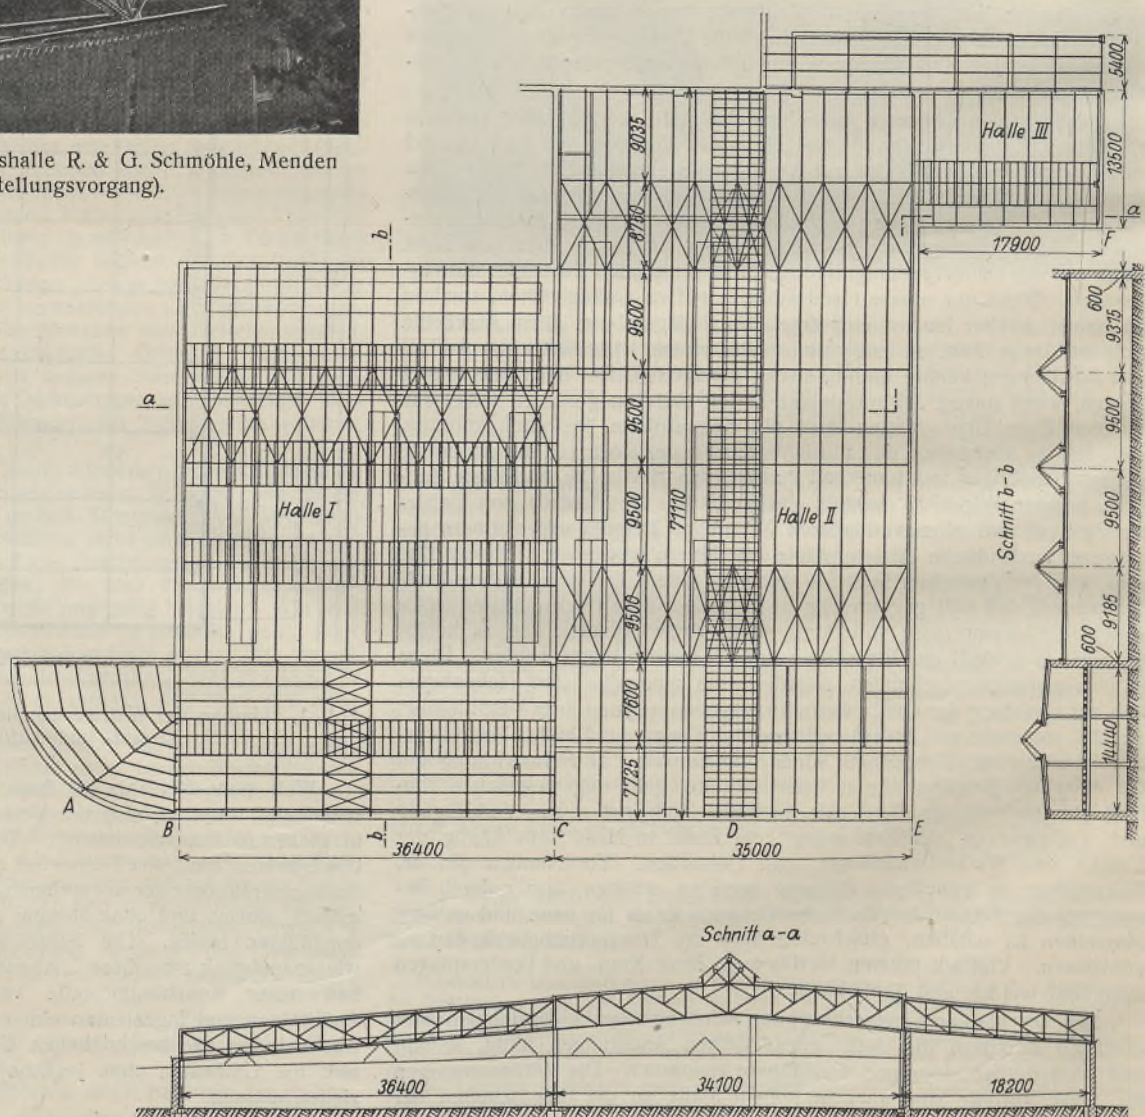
Umbau der Sperrholzfabrik Brüning & Sohn A.-G. in Ragnit, Ostpr. (Grundriß und Schnitte der umgebauten Fabrikhallen.)
